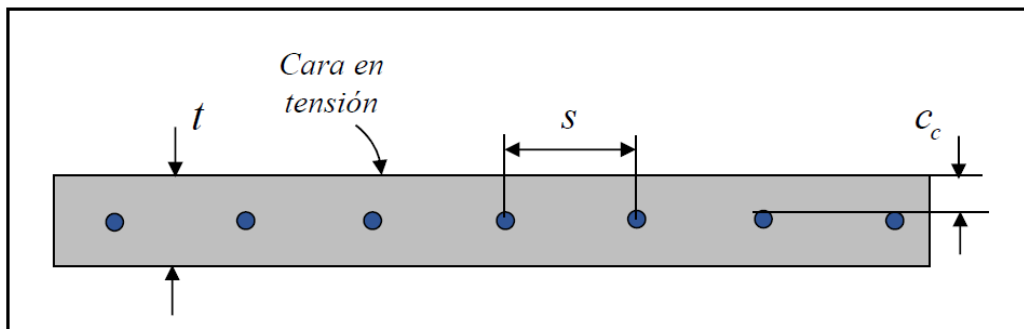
Definición de parámetros sobre disposición del refuerzo.
